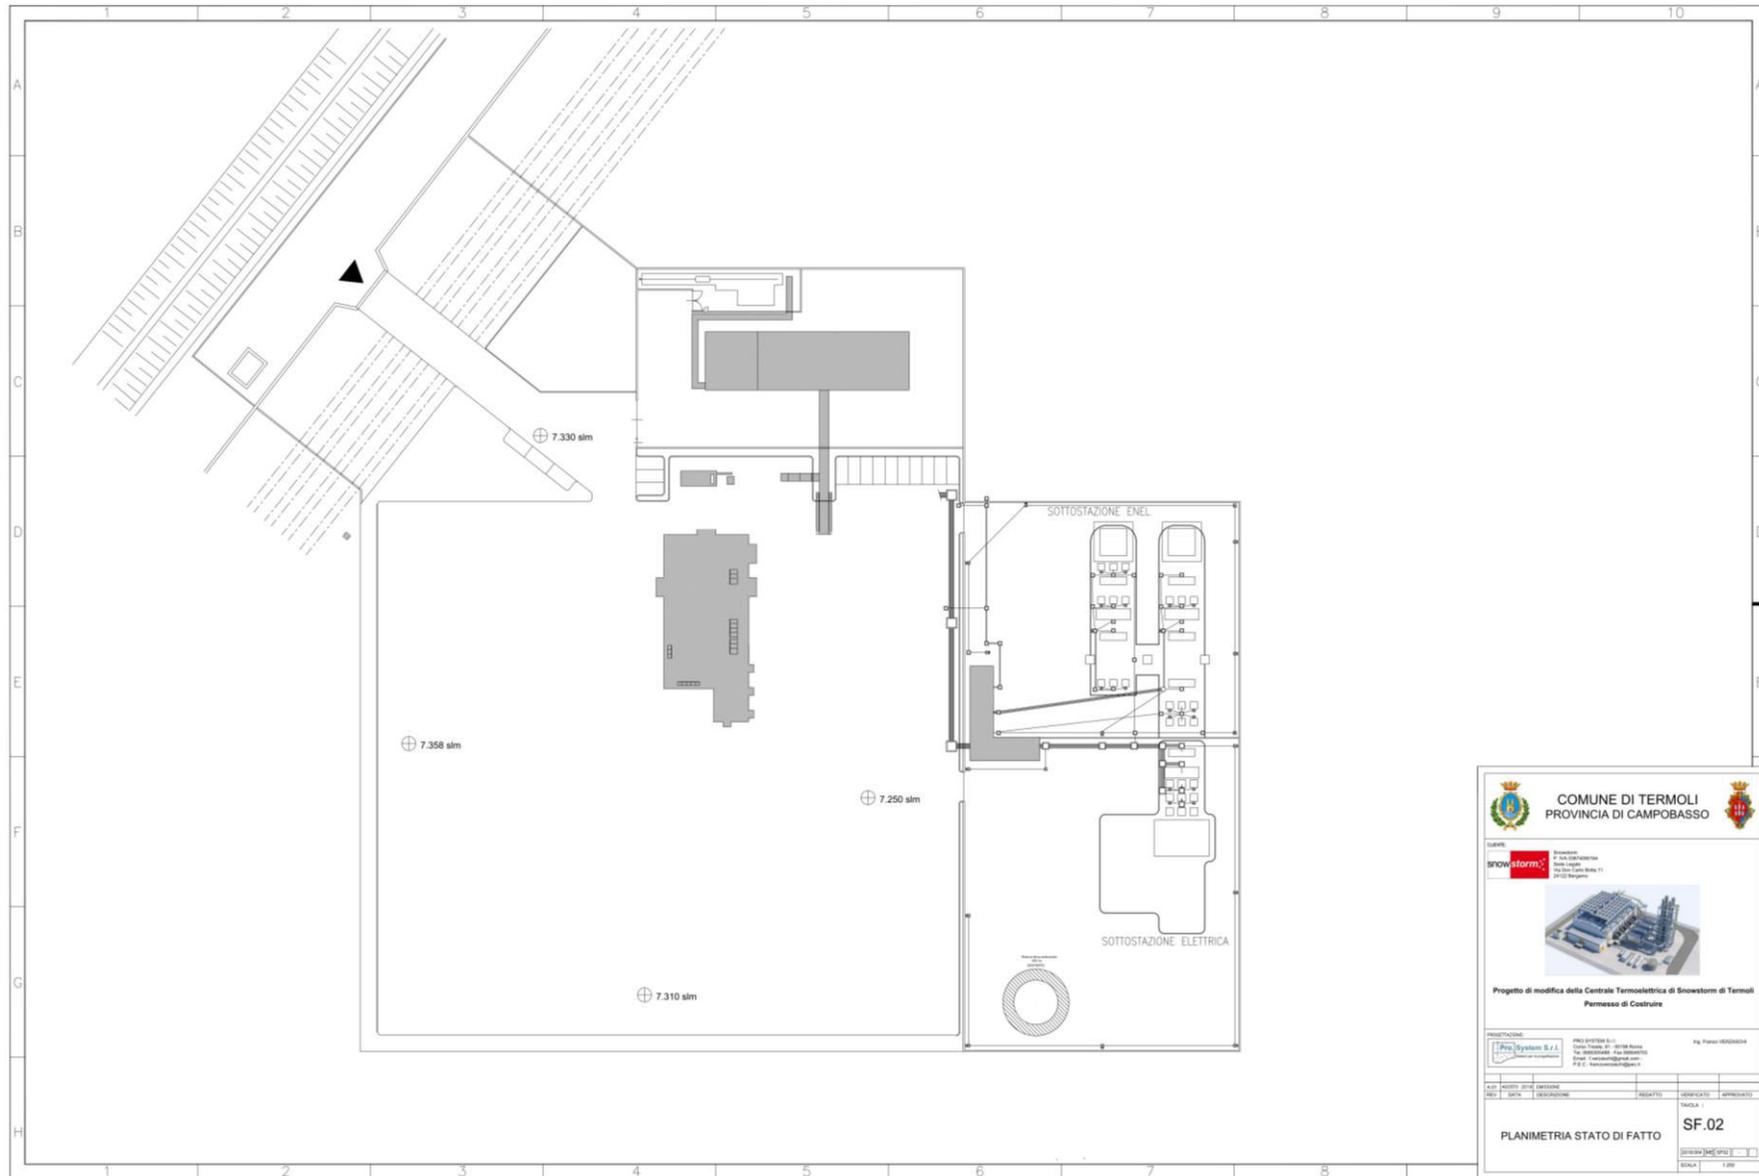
planimetria generale dell'installazione: stato di fatto dell'area oggetto di interventi di rifunionalizzazione e ammodernamento
